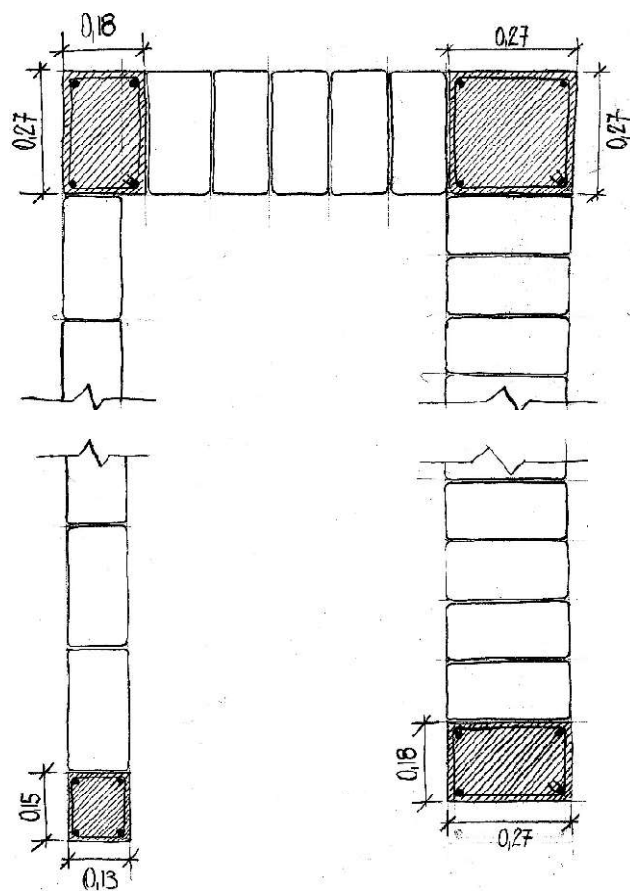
Encadenados Verticales en muros de ladrillo macizo
